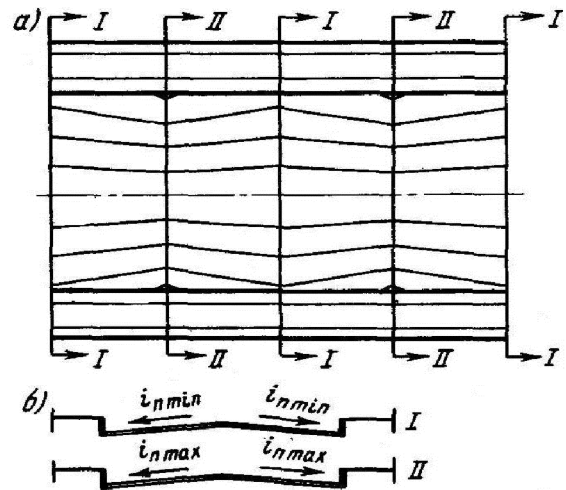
Вертикальне планування з пилкоподібним профілем лотка [53]: а) план вулиці; б) поперечні профілі
